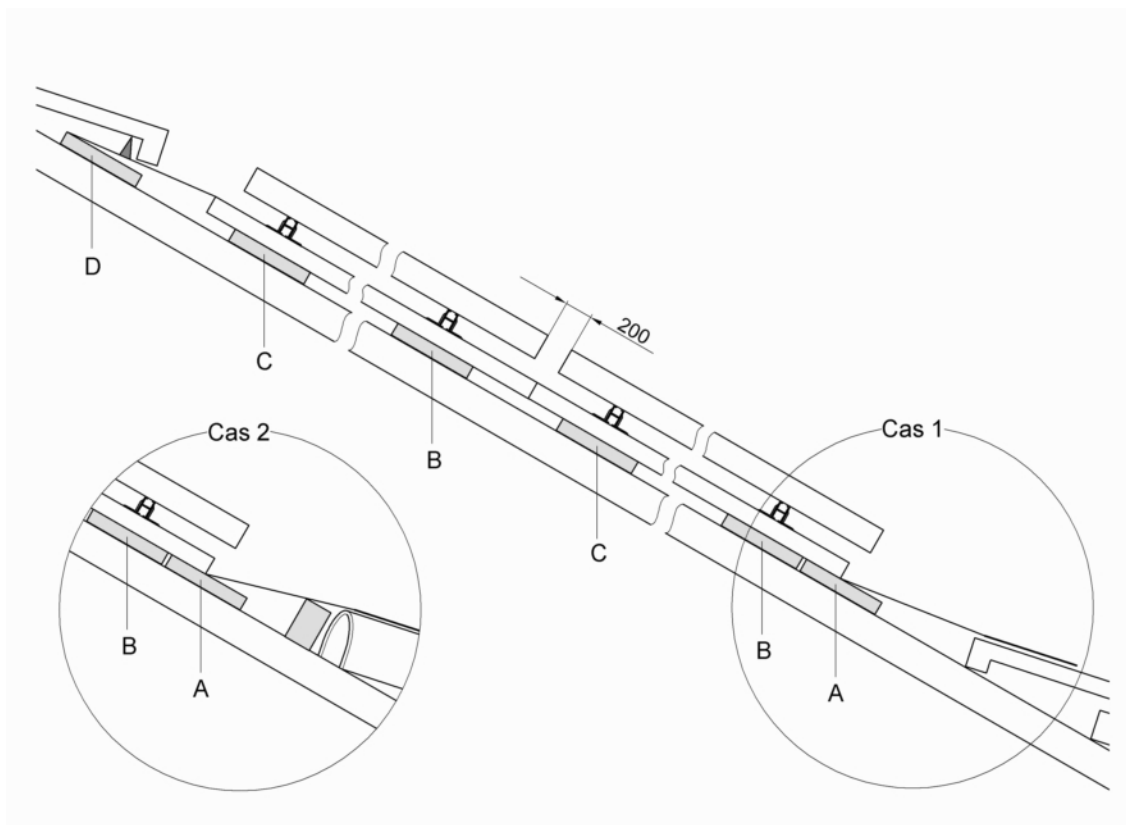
Plan en coupe de la toiture, présentation des deux cas de montage de la bavette
